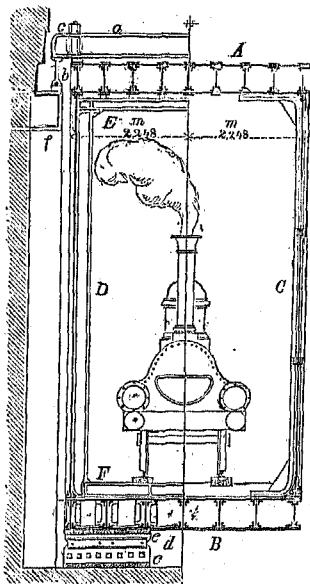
". — Поперечное сѣченіе фермы моста „Британія“.
